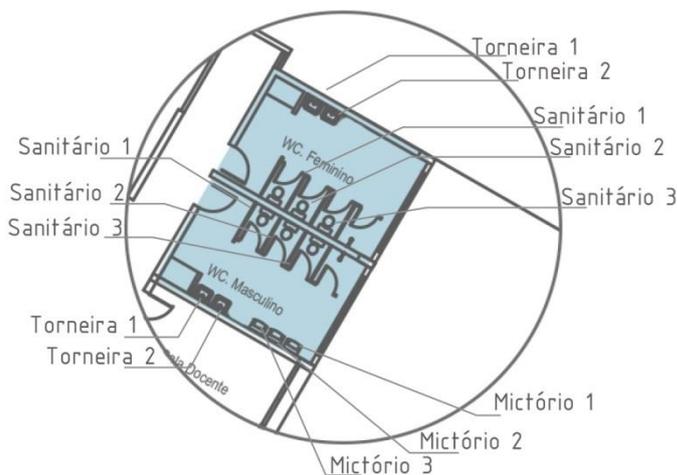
Planta do nível inferior do edifício, com detalhe da planta dos banheiros.
